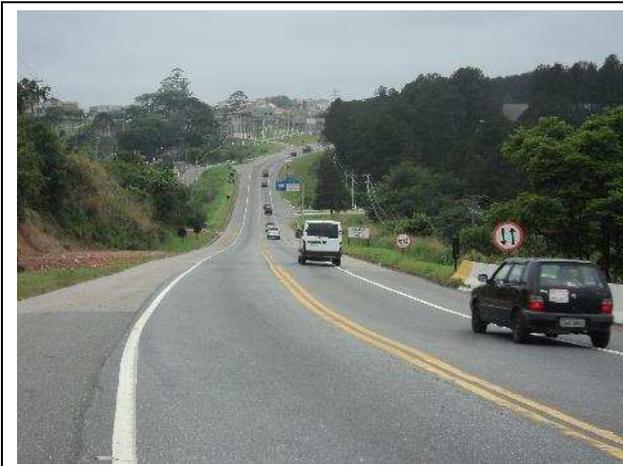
Vista geral do início do trecho – SP 088.
